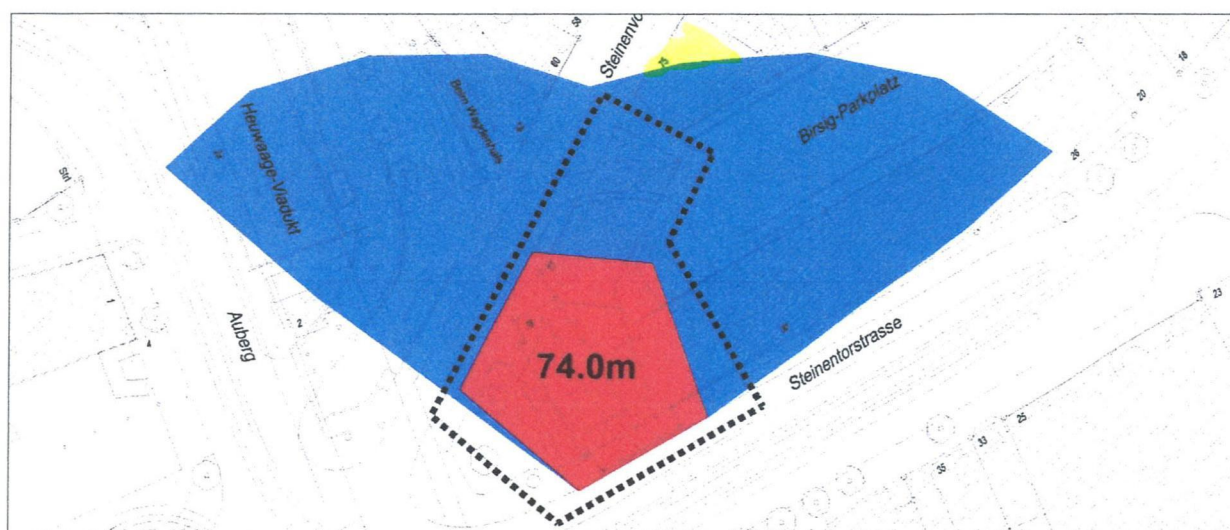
2 Stunden Schatten des geplanten Hochhauses. Höhe = 74 m. (Kein Massstab, Plan genordet)
